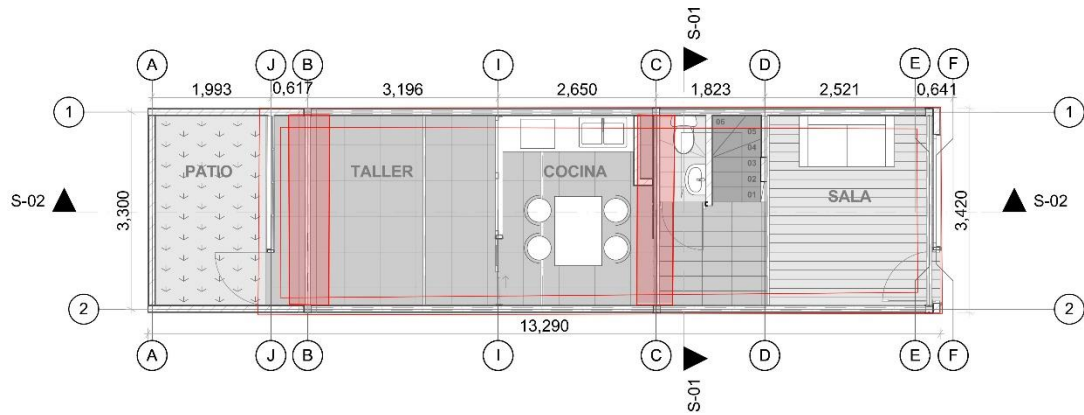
Planta primer nivel propuesta indicando cimentaciones a materializar. Elaboración propia 2017.
